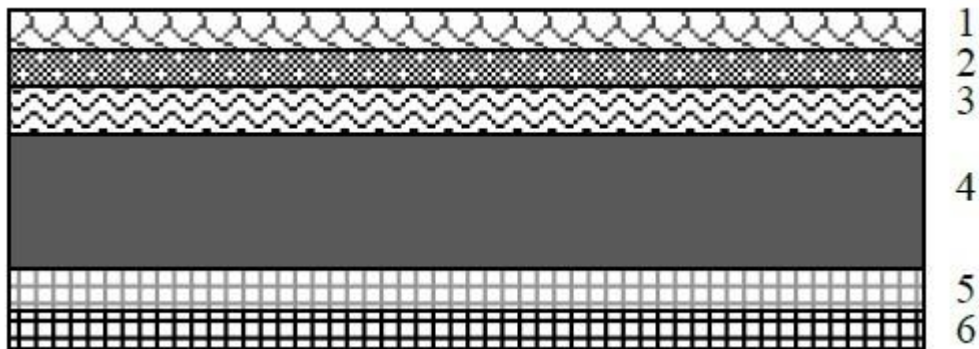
Coupe verticale du plancher courant à dalle pleine
